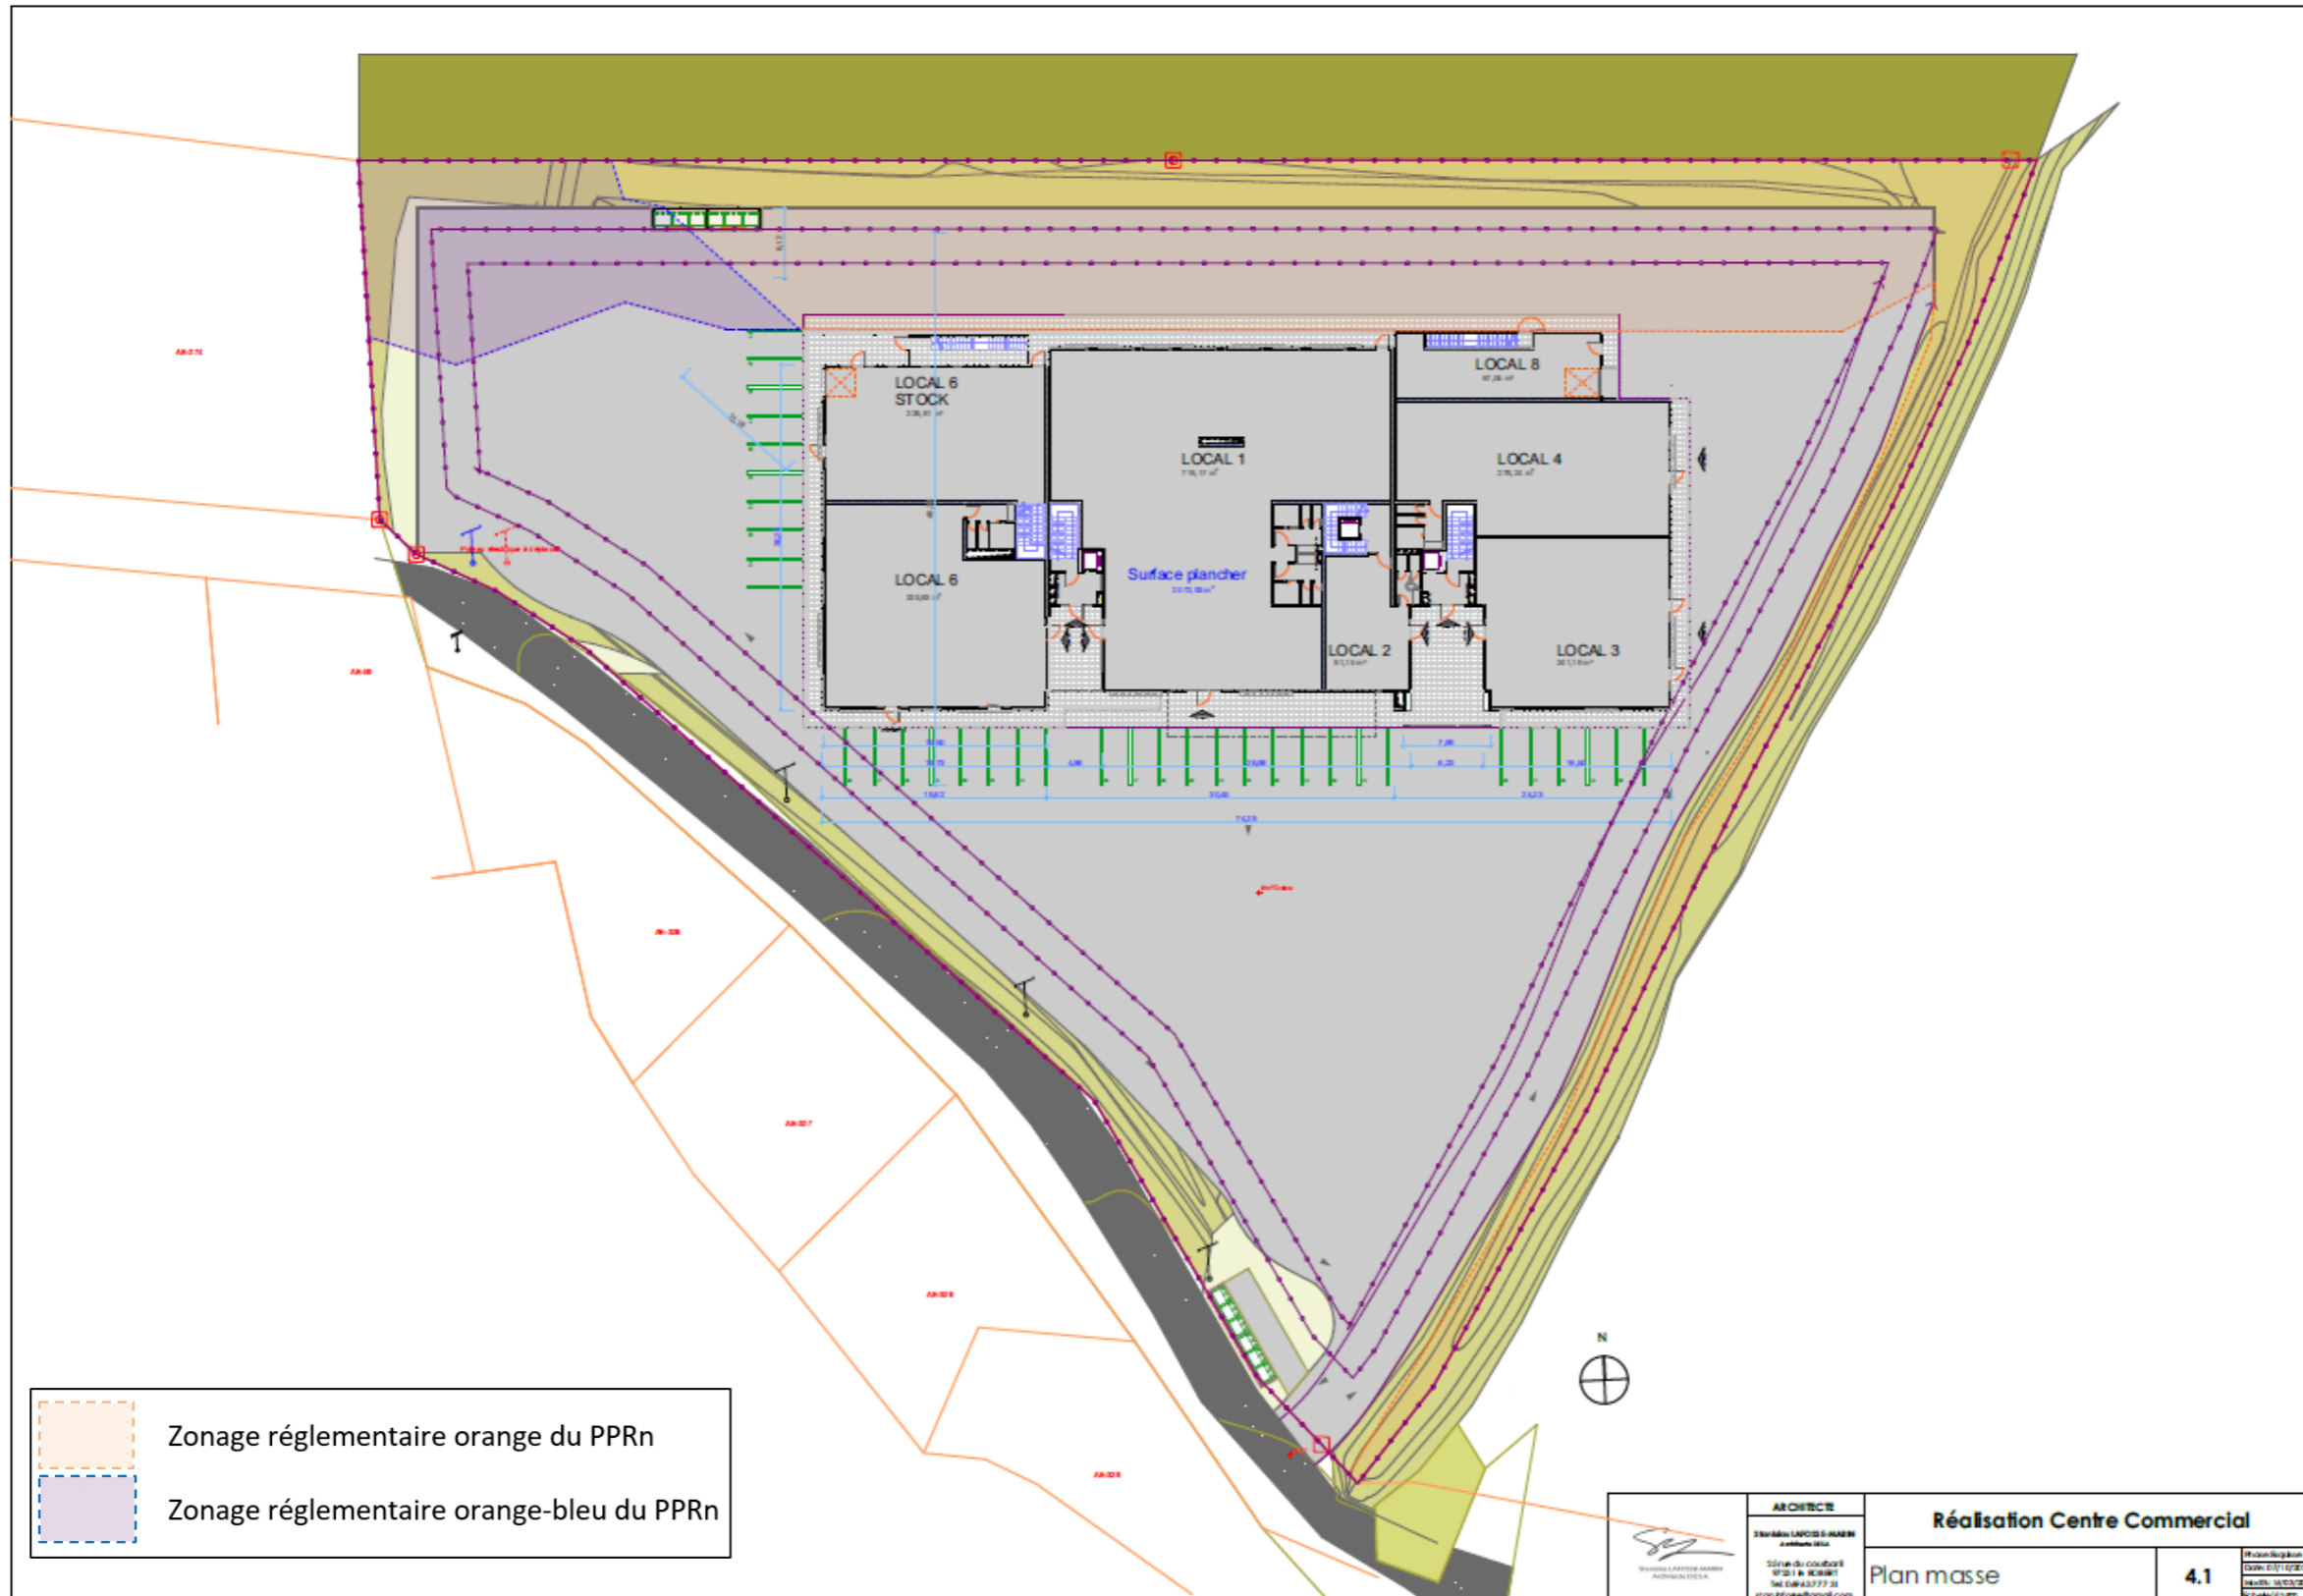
Plan de masse provisoire du projet (source : Architecte Stanislas LAFOSSE-MARIN, version du 14/12/2020 et annotations BURGEAP)
